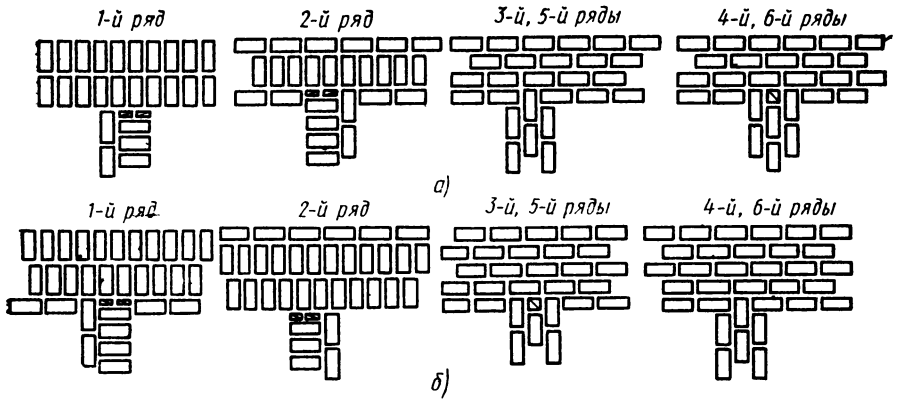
Порядовая раскладка кирпича по многорядной системе перевязки швов при кладке примыканий стен толщиной:
